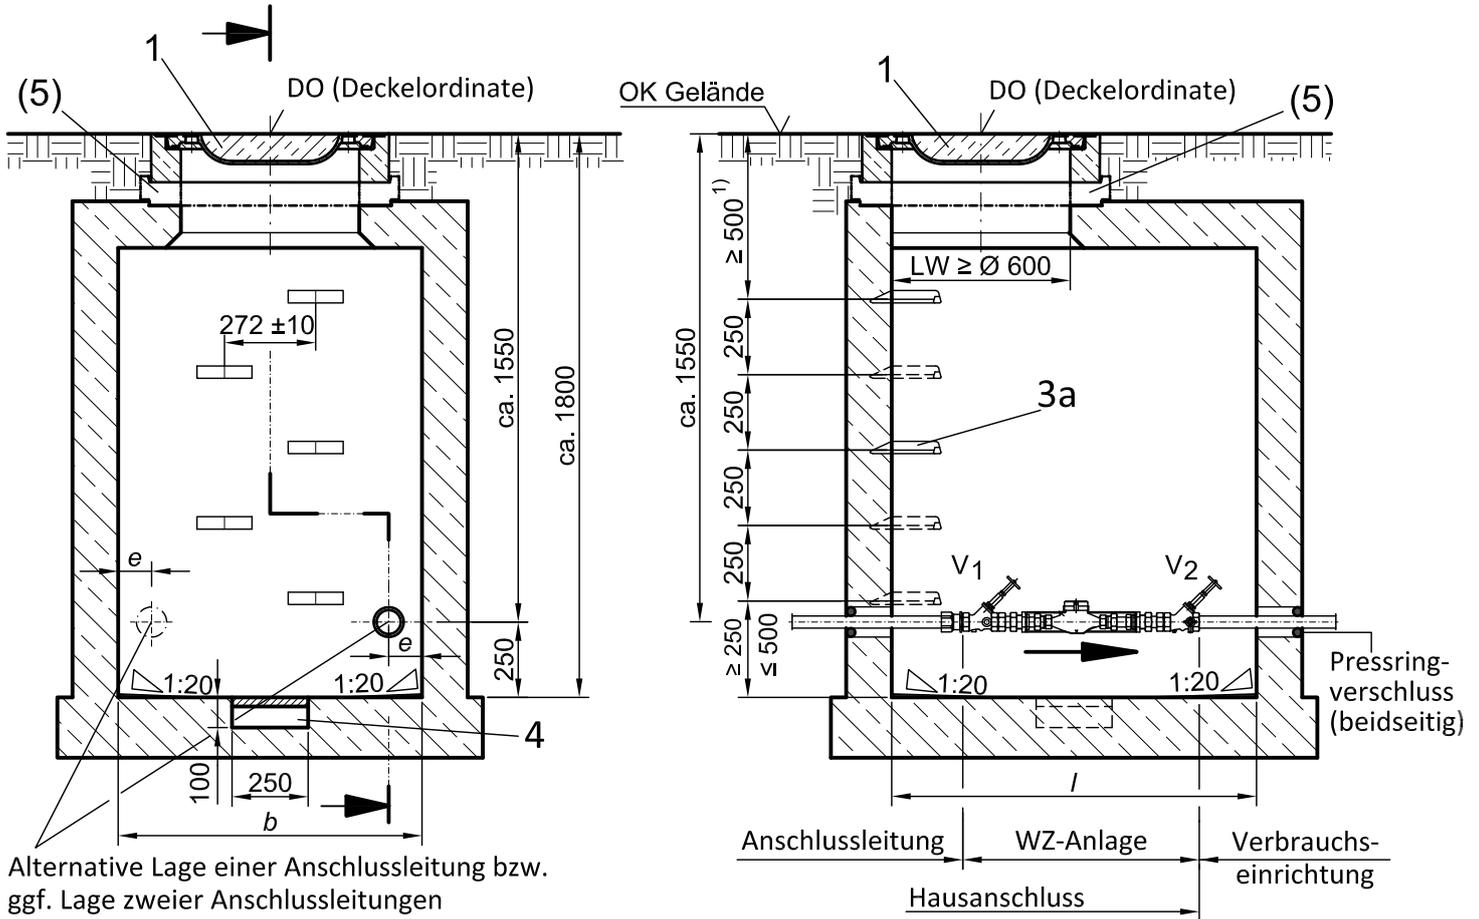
Wasserzählerschacht aus Betonfertigteilen
